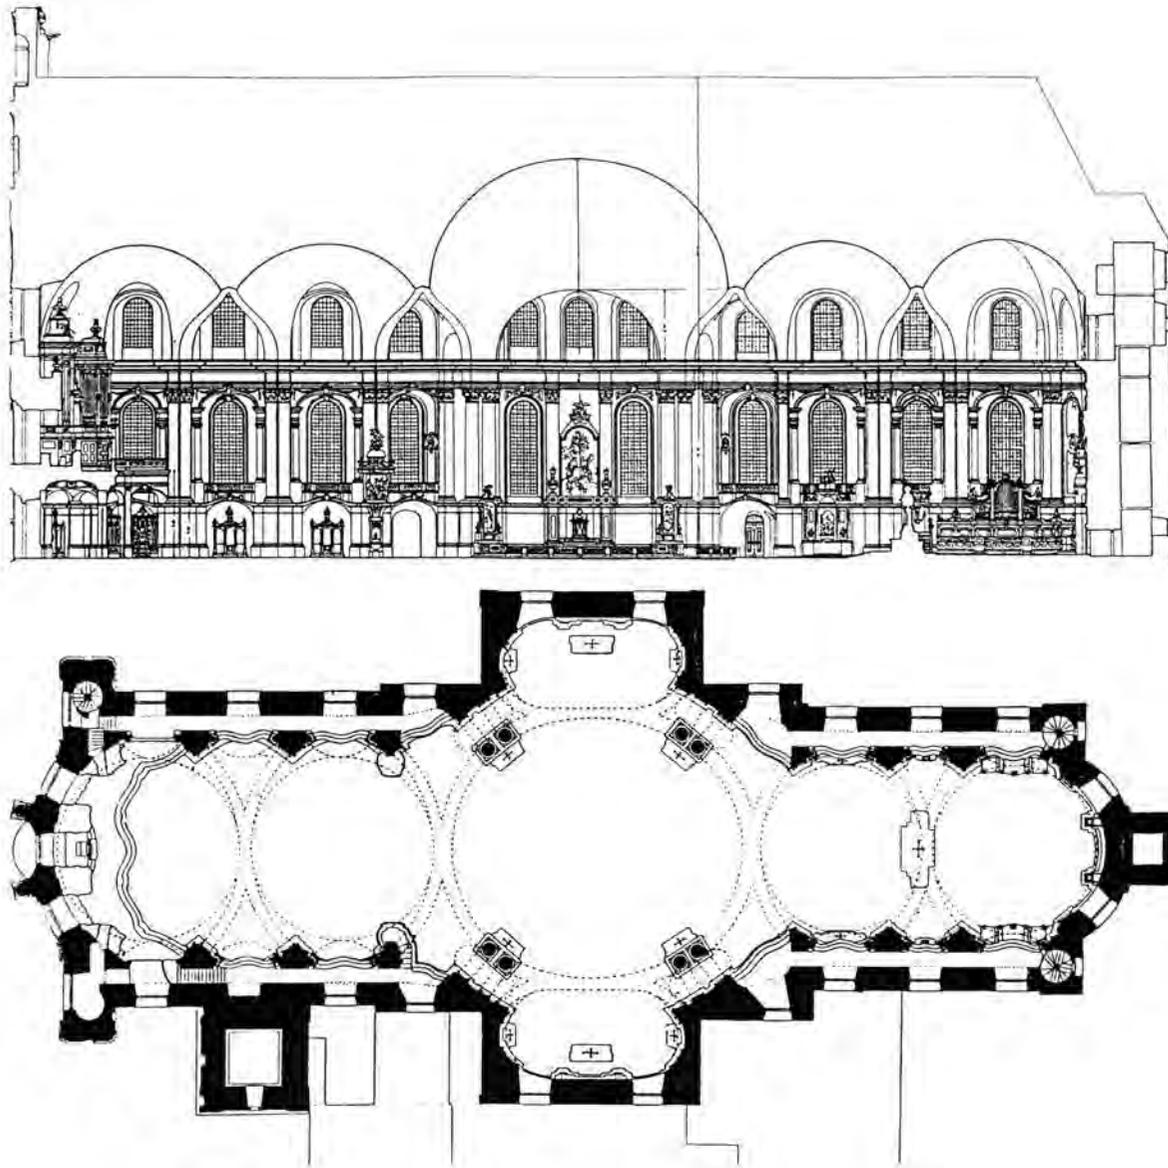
Abteikirche Neresheim, Grundriss und Längsschnitt, aus /47/
